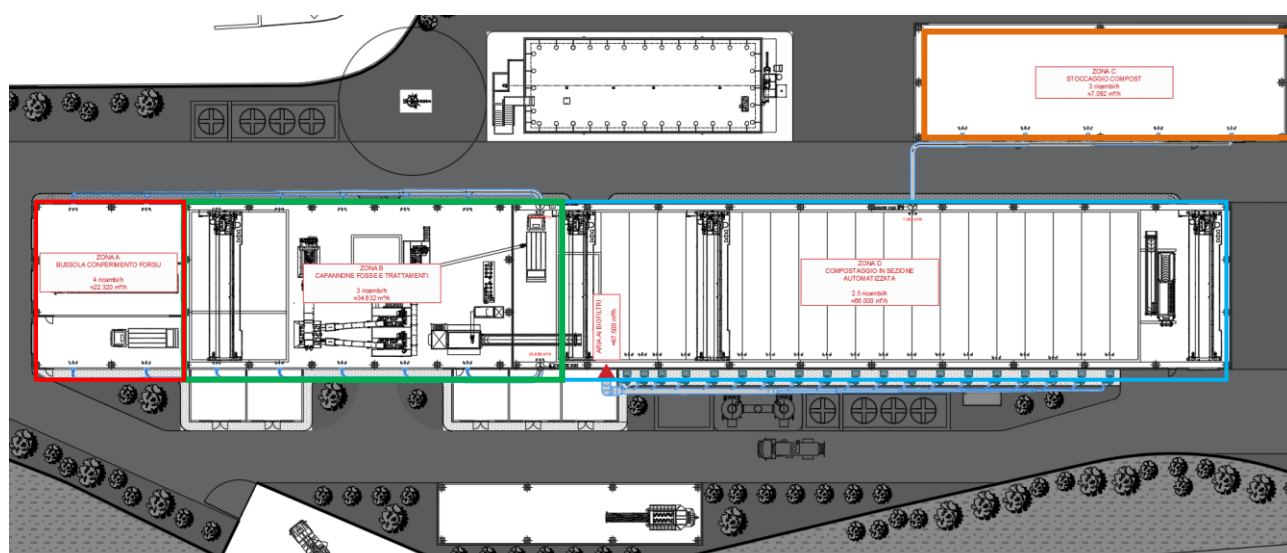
Planimetria trattamento aria estratto tavola T.18 - Planimetria trattamento aria
